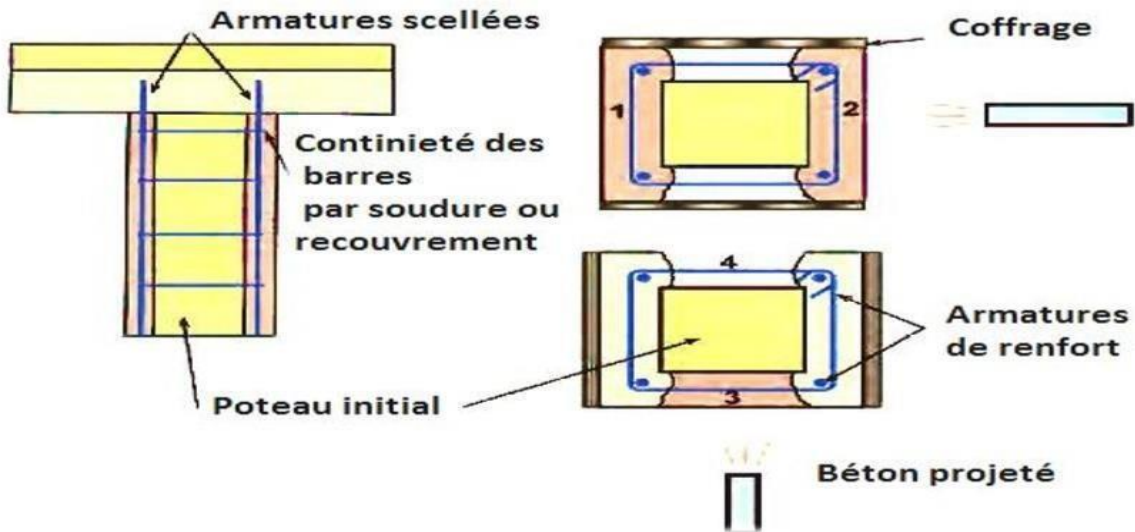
exemple de renforcement d'un poteau par ajout de béton et d'armatures
